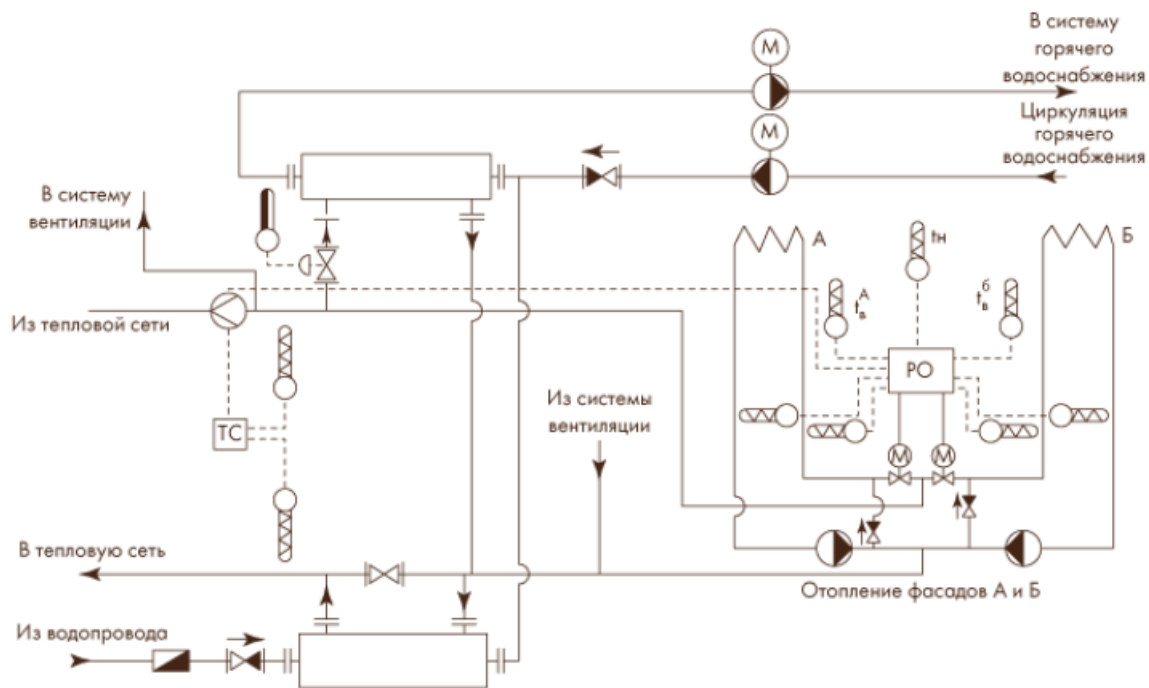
Тепловая схема ИТП с по фасадным регулированием систем отопления
